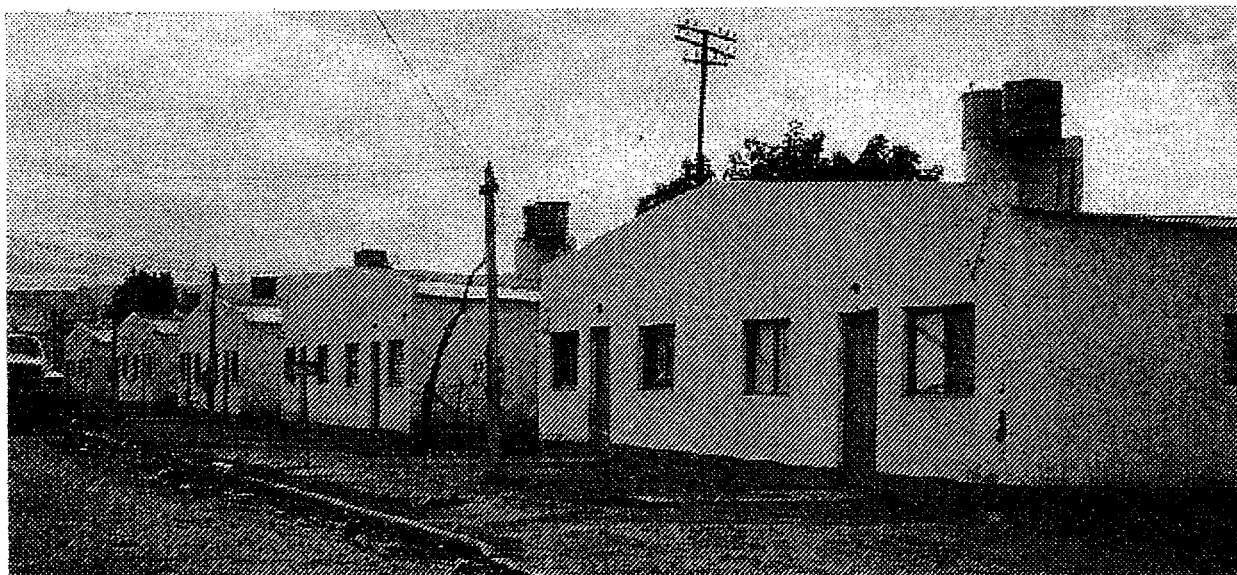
Barrio Muñecas I. Construcción de los módulos habitacionales
